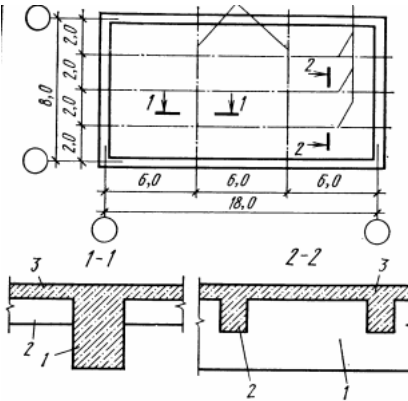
Залізобетонне монолітне ребристе покриття:
